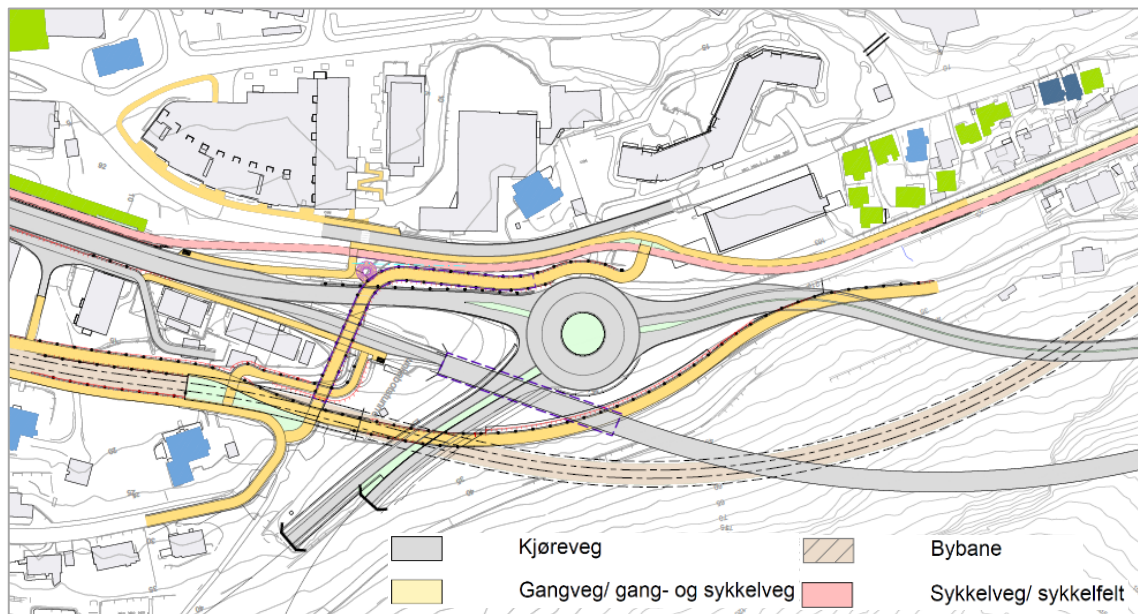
Planskisse kryssløsning Eidsvåg.
